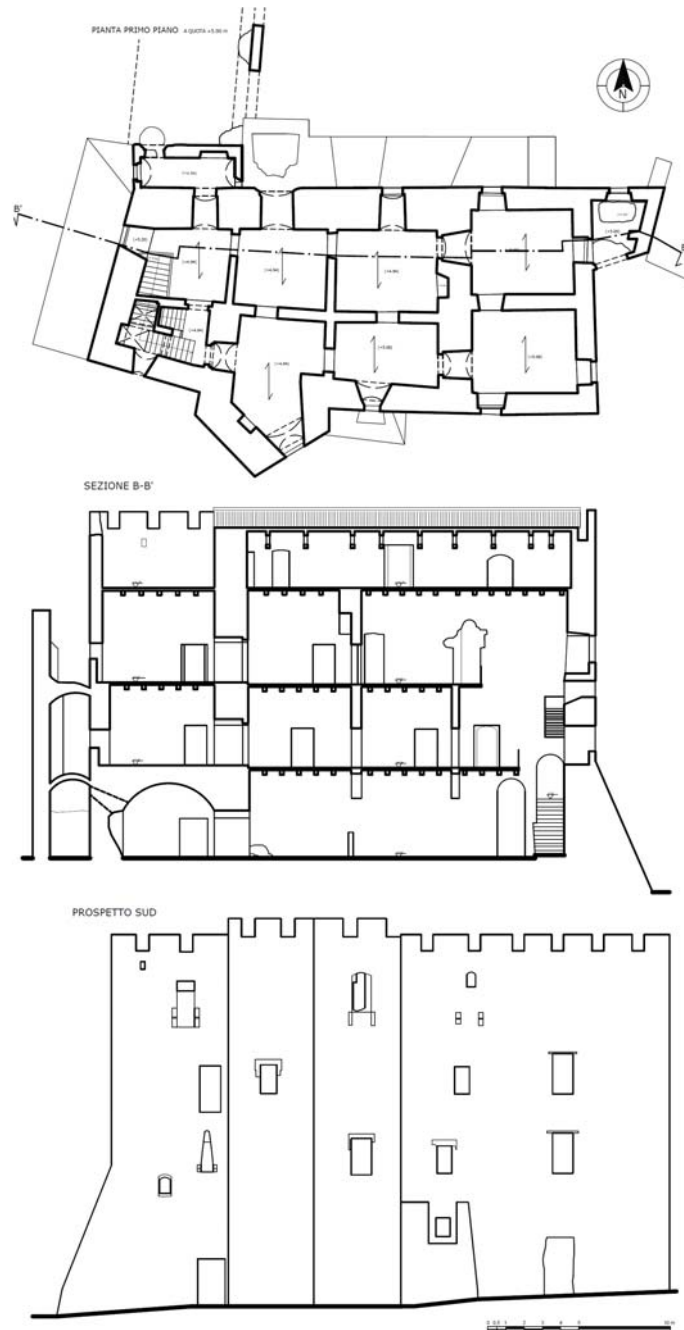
Una pianta, una sezione e un prospetto elaborate in ambiente CAD
